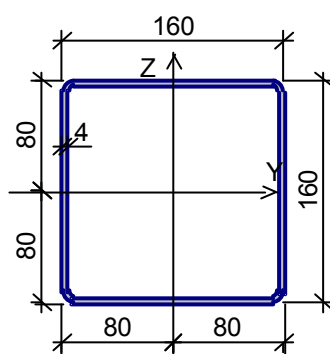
Принятое поперечно сечение стоек фермы
